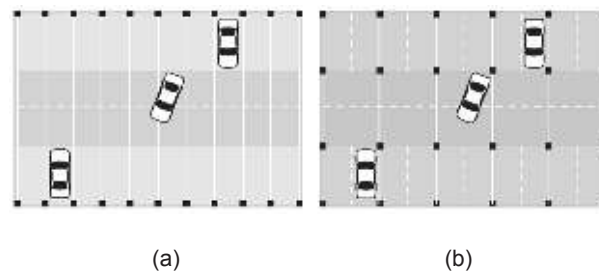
Arranjo de vigas e pilares em edifícios-garagem (adaptado de Steel Framed Car Parks – Corus)
